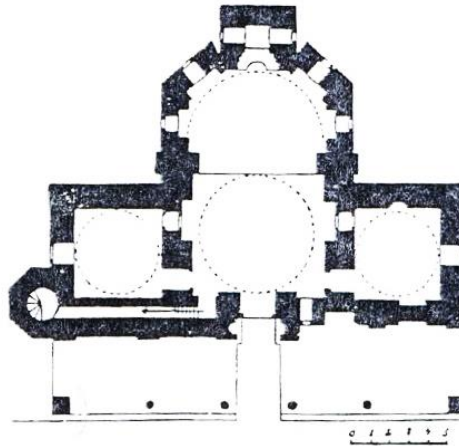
Bursa OrhanBey Camii Planı [5]
